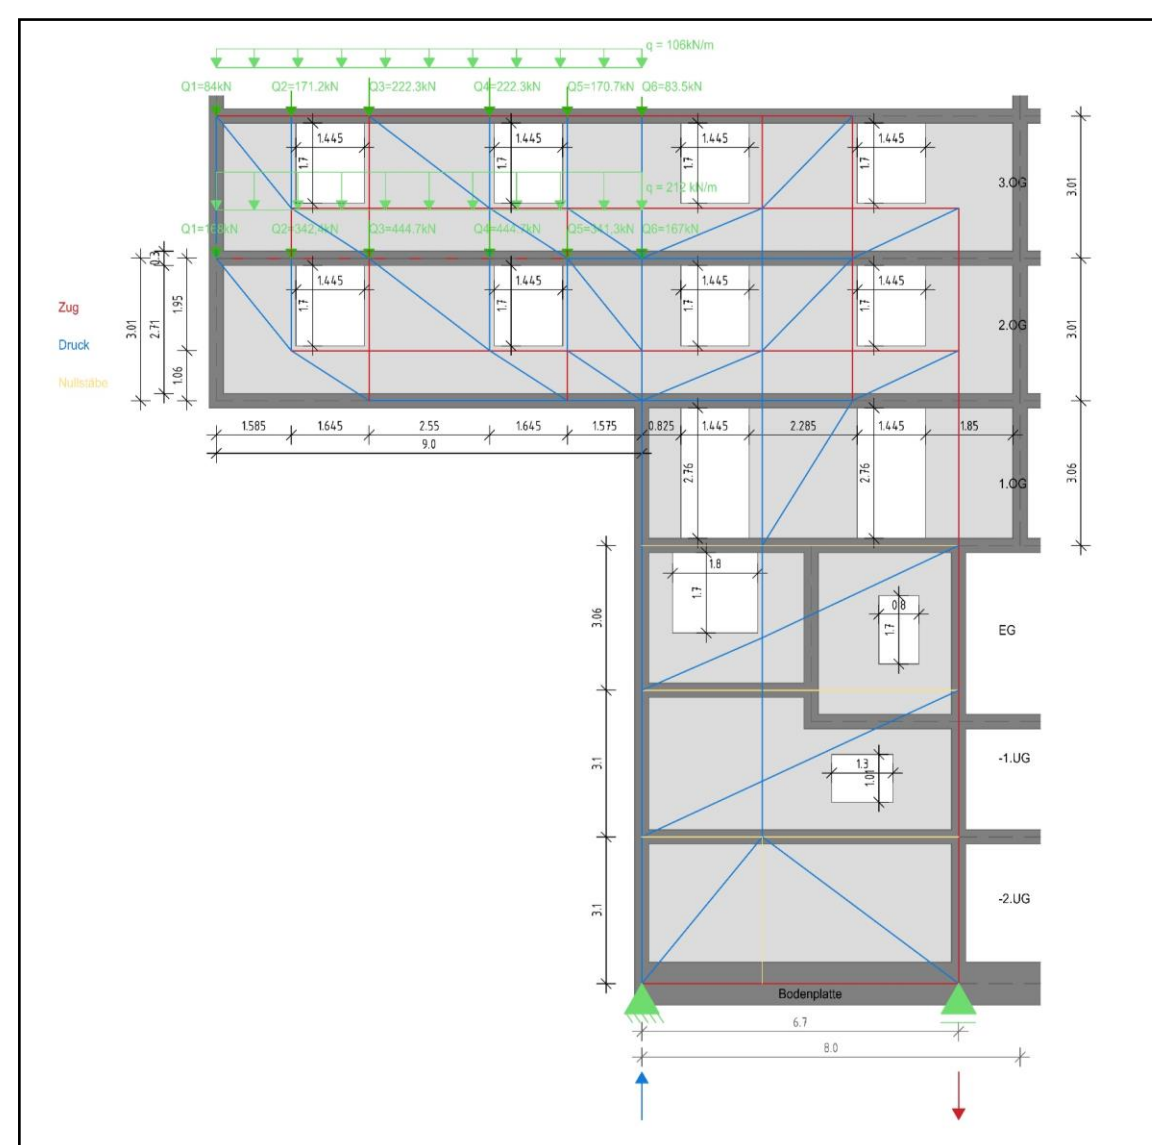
Fachwerkmodell der Wandscheibe (1. & 2.Geschoss)
